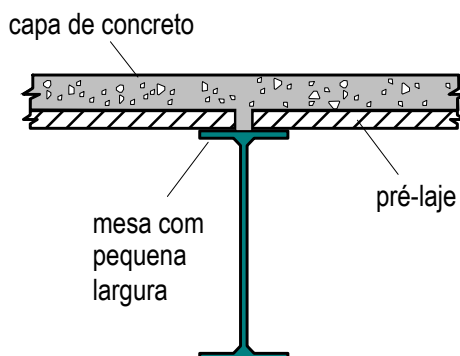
Sistema de piso misto com pré-laje de concreto.
